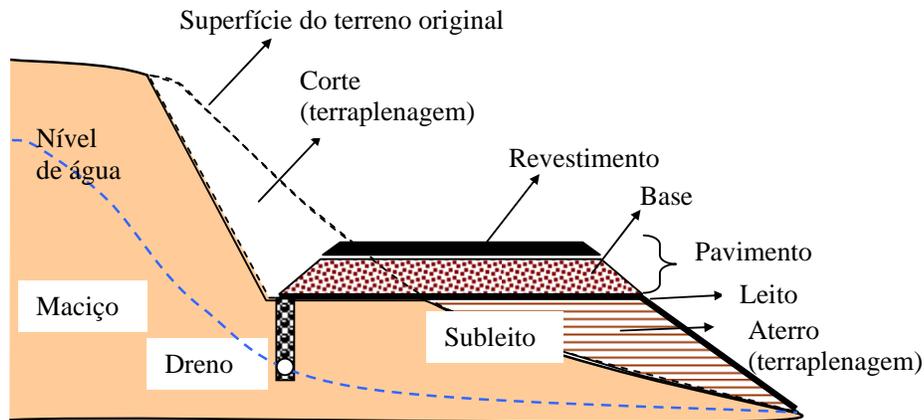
Componentes típicos na estrutura de um pavimento rodoviário.
